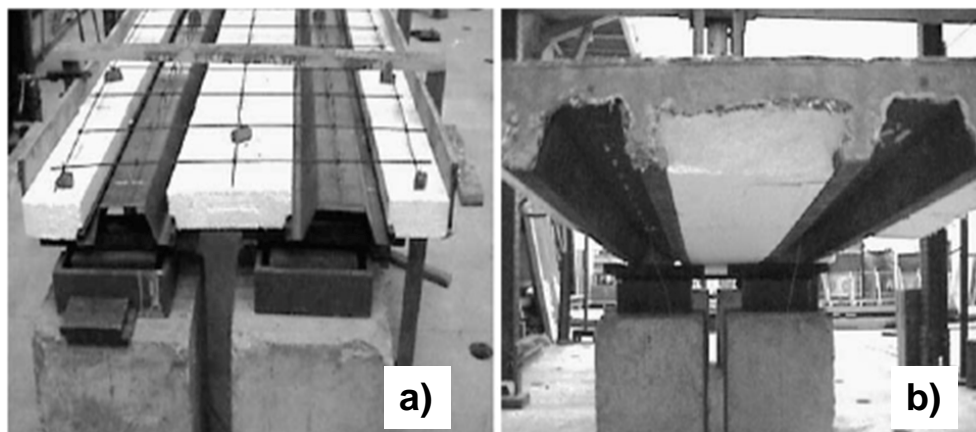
Sistema de laje mista idealizado. Fonte: Andrade et al (2004)
